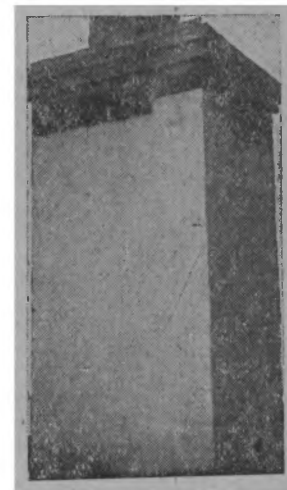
Пята свода оперли на насадку. Расширившаяся от нагрева насадка В подняла верхушку печи и появилась трещина. Верх печи закопчен дымом.
